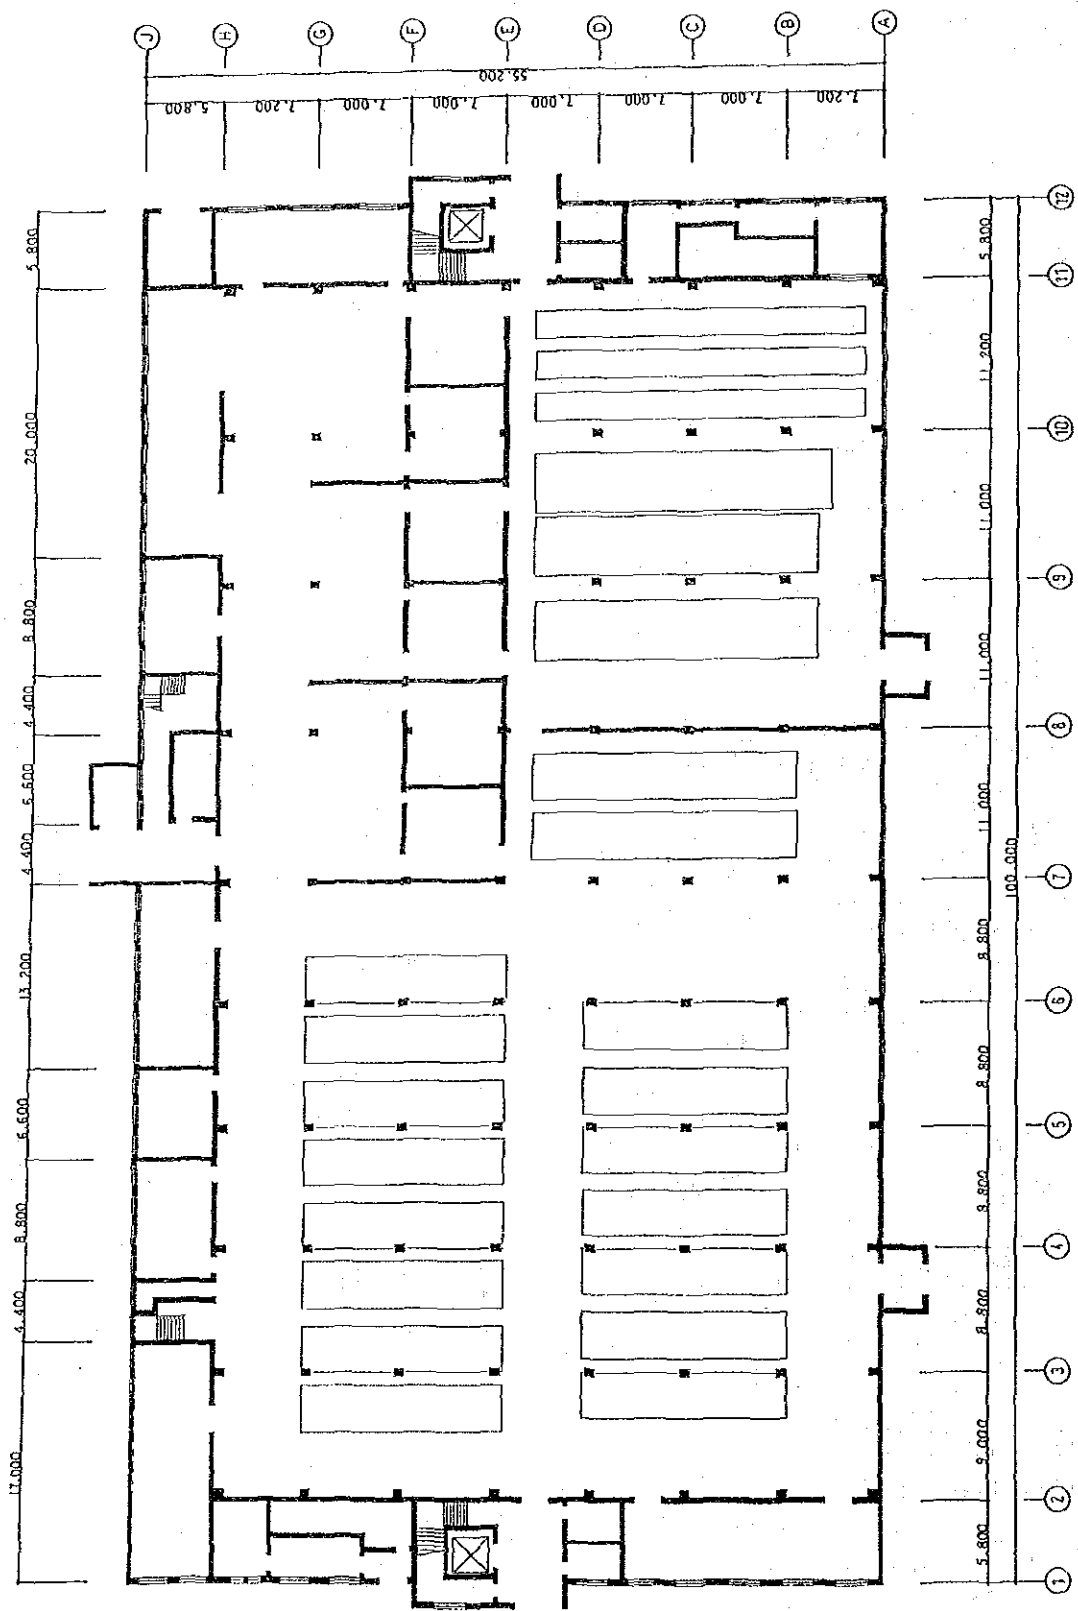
2 2 第一毛紡 紡毛紡績職場 (1 階) 平面图
